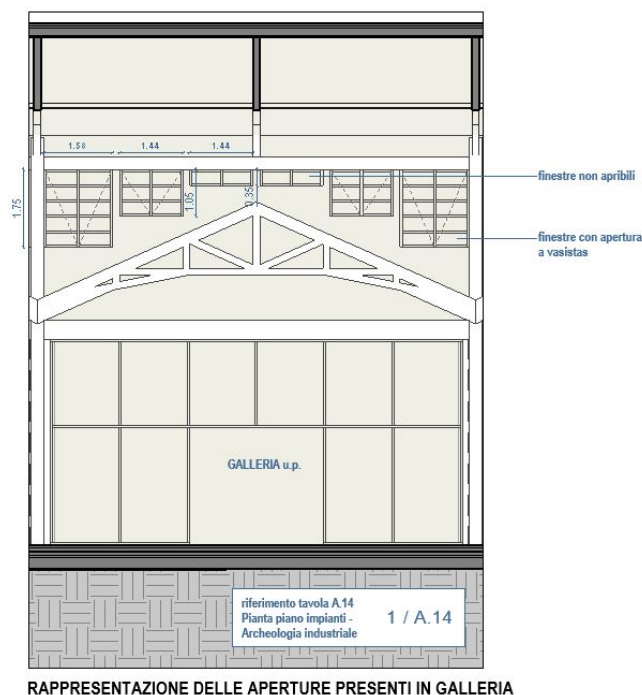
Porzione di prospetto interno della galleria con indicate le aperture sull'esterno
